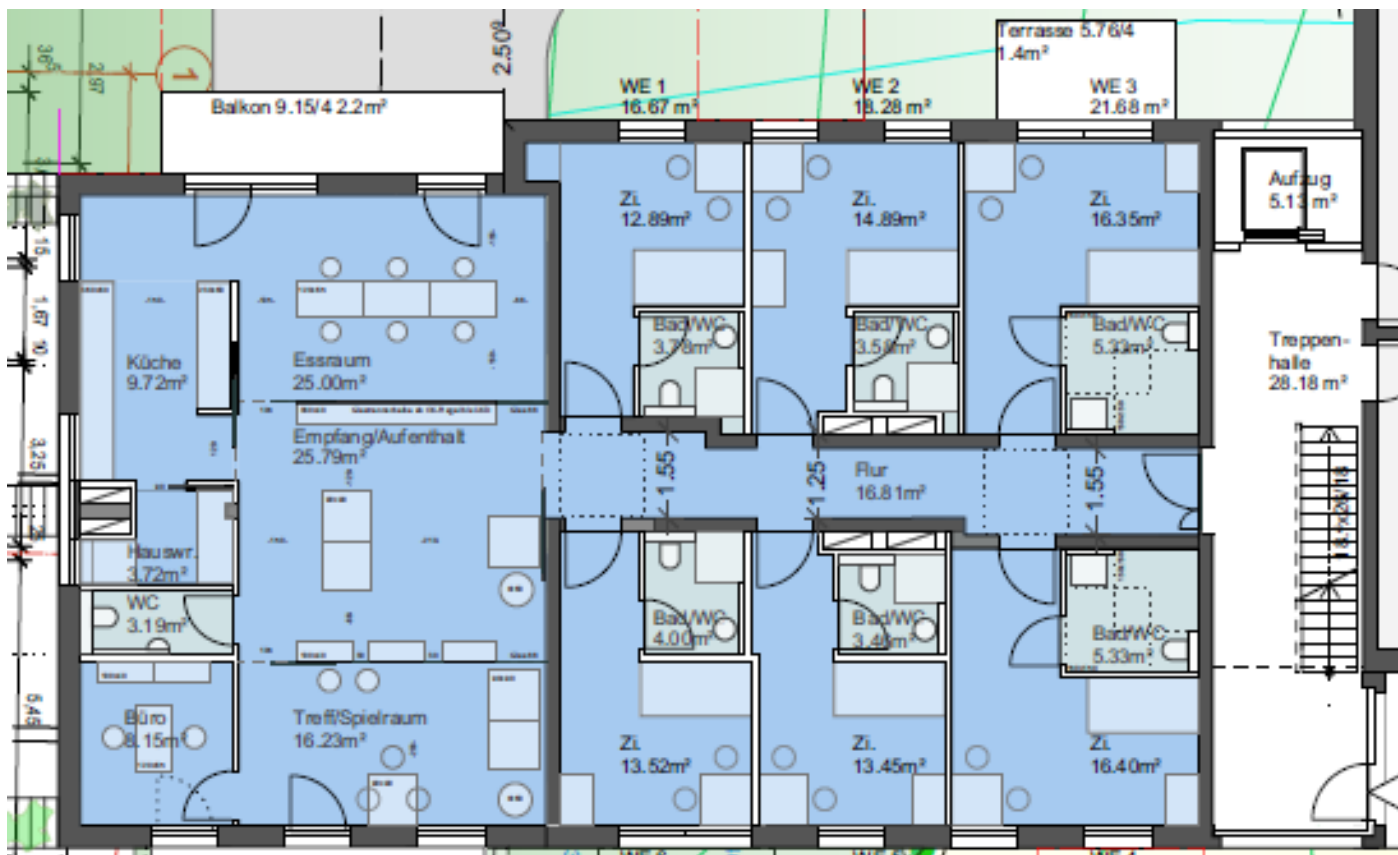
Grundriss der Inklusiven WG Metzingen
